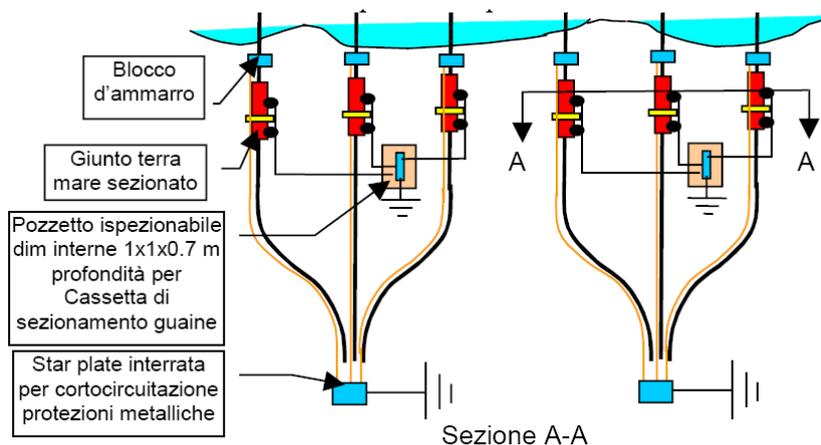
Schema tipico della cameretta di giunzione tra cavo marino e cavo terrestre
